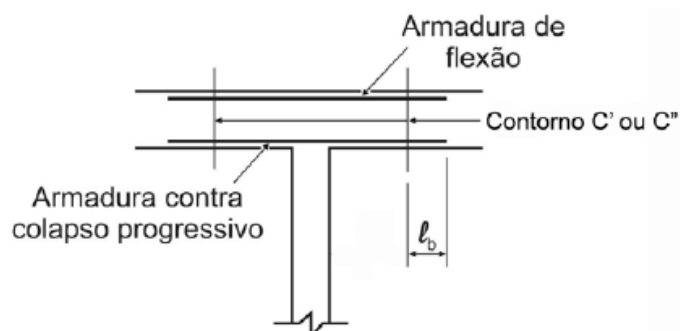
Armadura contra colapso progressivo (NBR 6118:2007).
